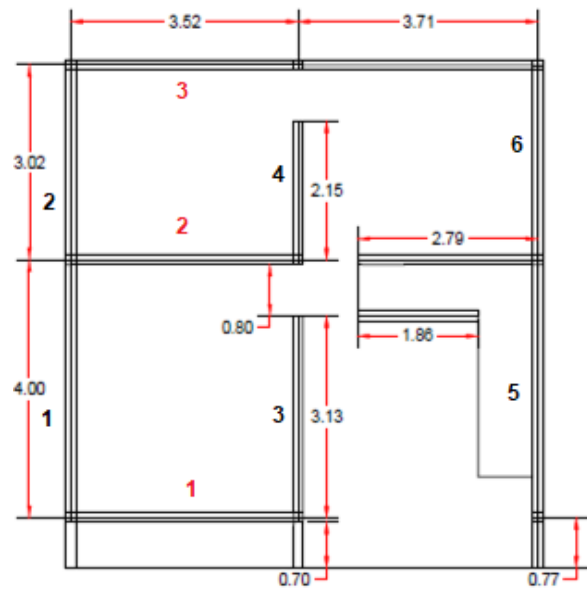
Dibujo en planta de vivienda tipo 2, del nivel 2 (Fuente: Elaboración propia)
